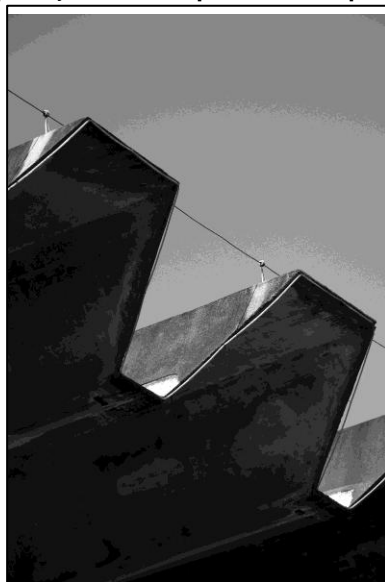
TRRM. Projeto: Brena e Carlevaro [1976] Detalhe da cobertura - 2009
